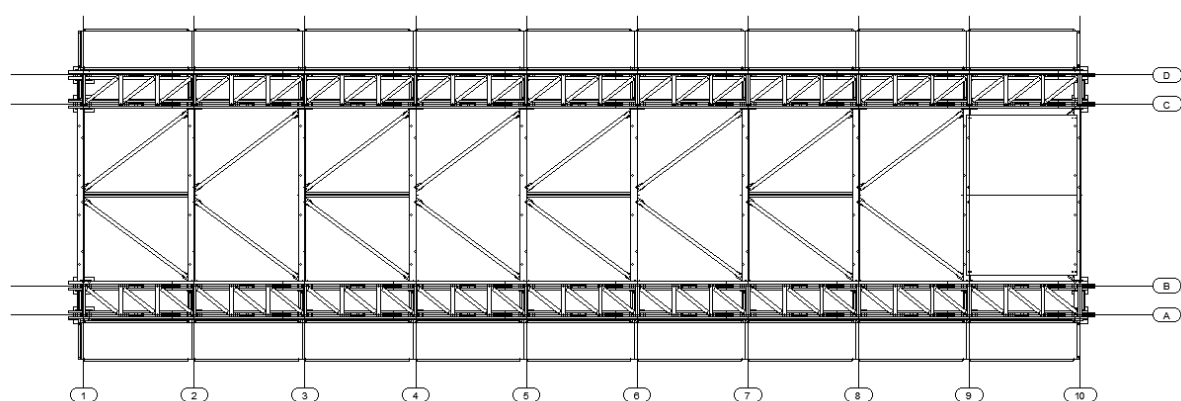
Desenho em AutoCAD da planta da ponte de 27,432 m, com passarelas para os peões (gentilmente cedido pela BERD)
